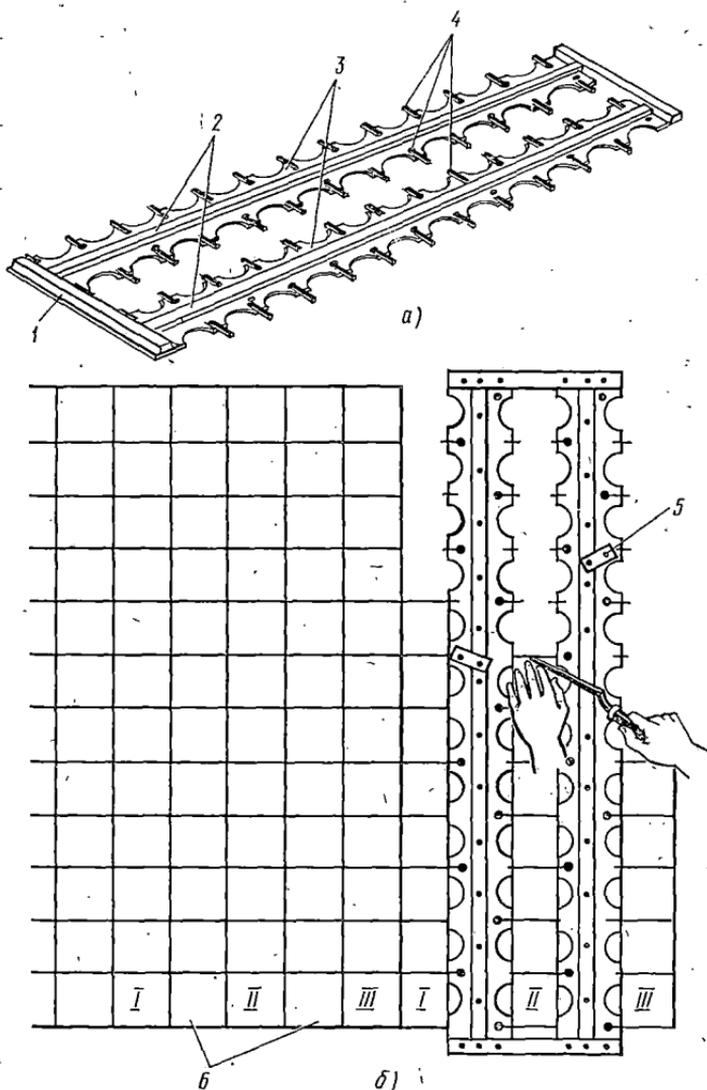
Облицовка стен с использованием спаренного шаблона:
